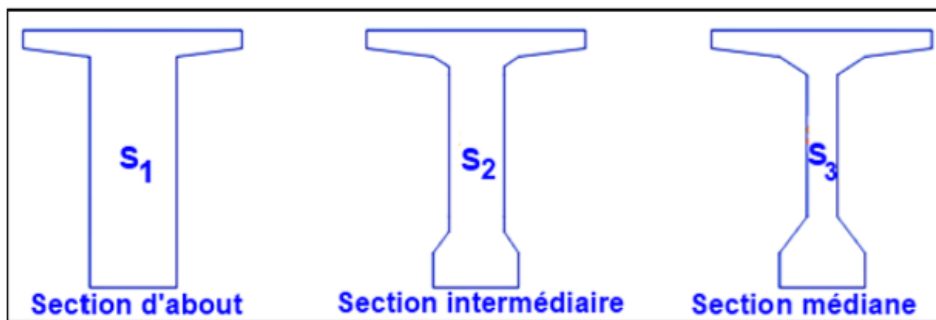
Sections transversales de la poutre de travée intermédiaire
